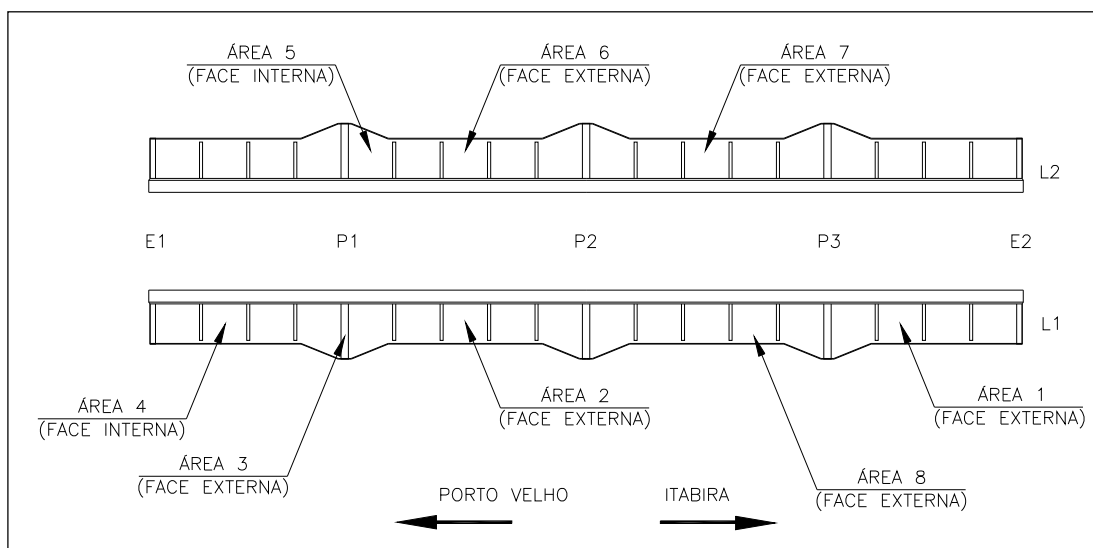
Localização das áreas selecionadas para estudo detalhado.
